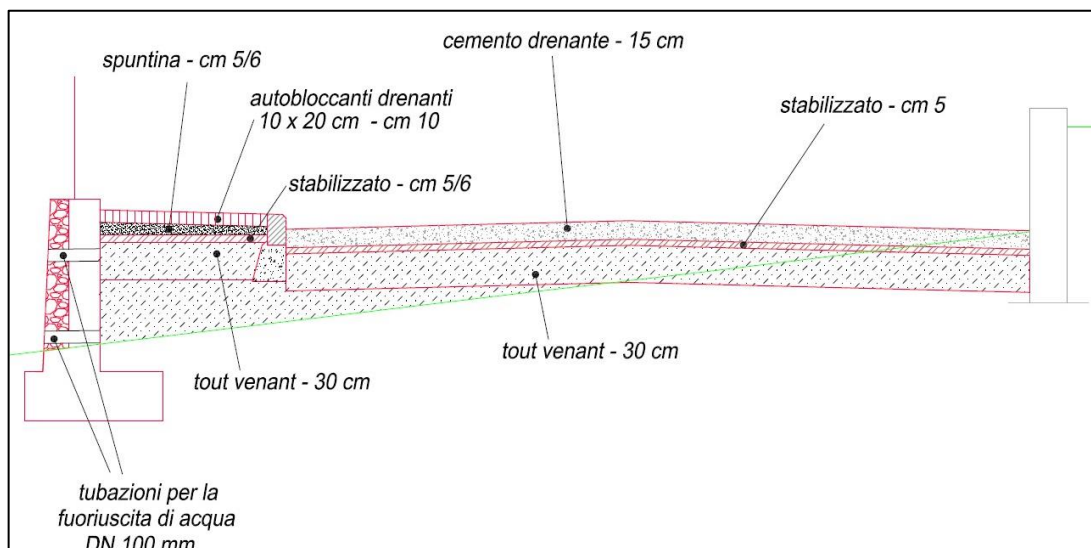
Sezione tipo sulla strada di lottizzazione in rilevato
